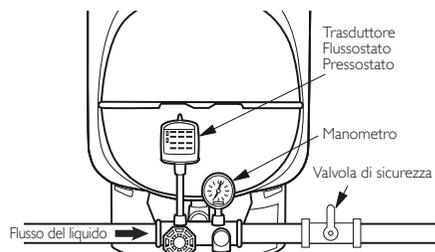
Installazione del vaso d'espansione con accessori
